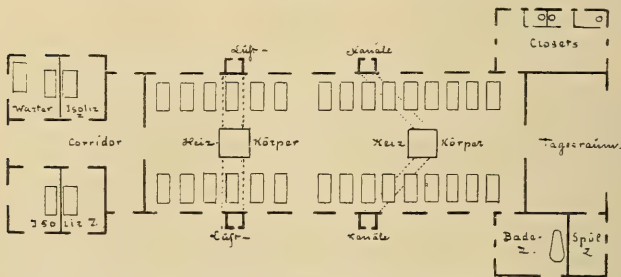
Pavillon des Hamburger Krankenhauses (nach Deneke).
